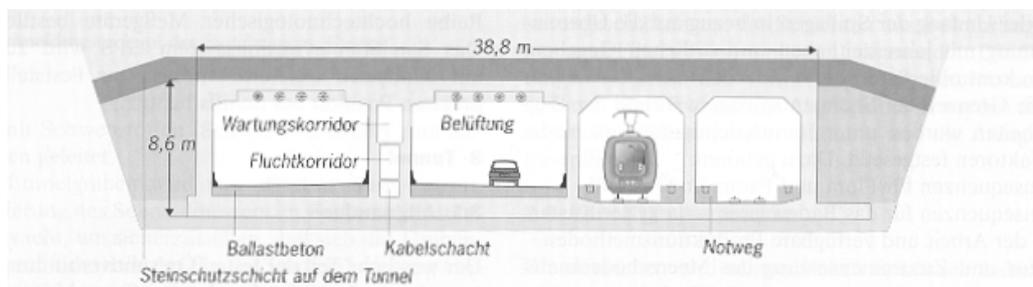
Querschnitt Senkkastenelement Oeresund
